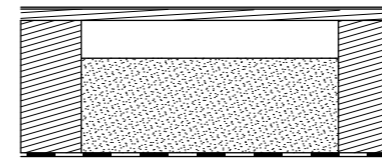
Fußboden Gebäude Gl. 1:20
